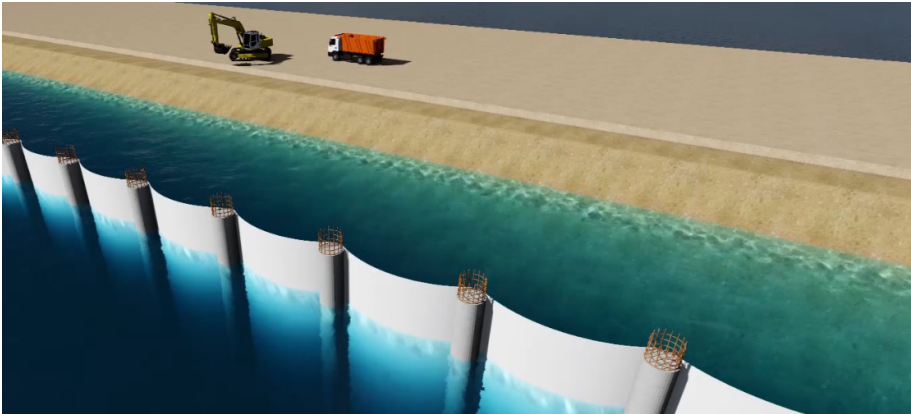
Recreación de láminas colocadas entre los pilotes. Adaptado con permiso de ref. [7].
